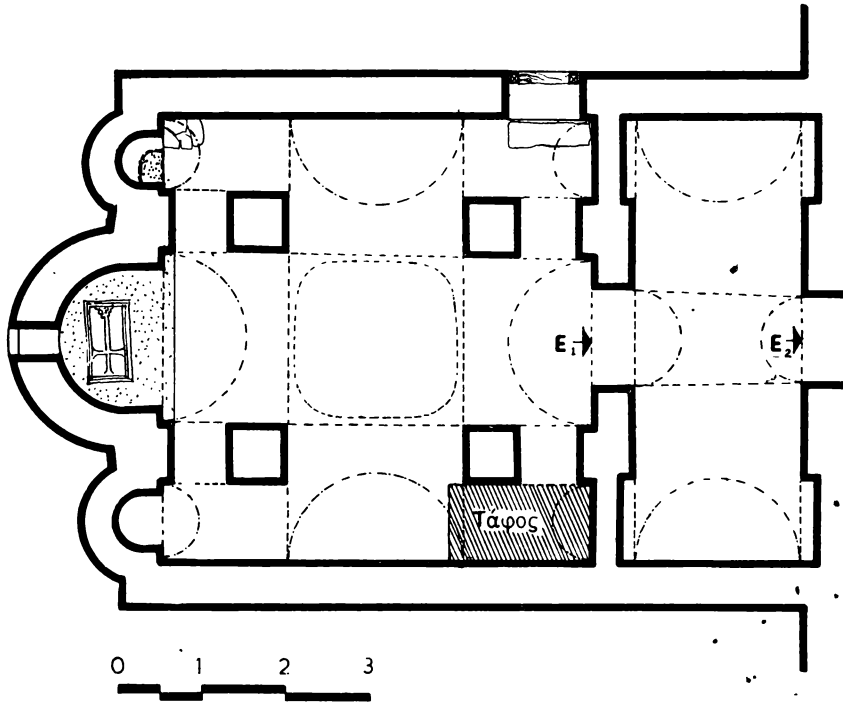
Grundriss der Hl. Germankirche.
